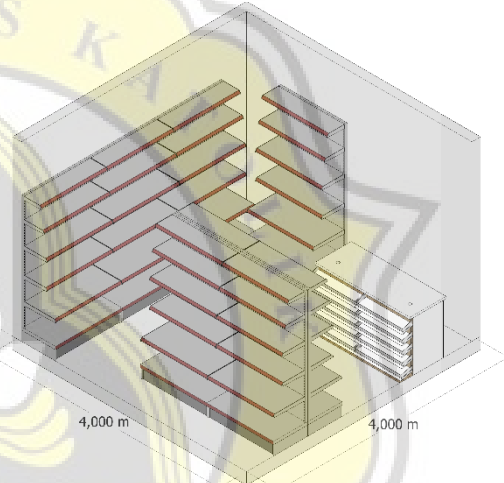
Layout *Tenant* 4×4 meter Klaster Kuliner
